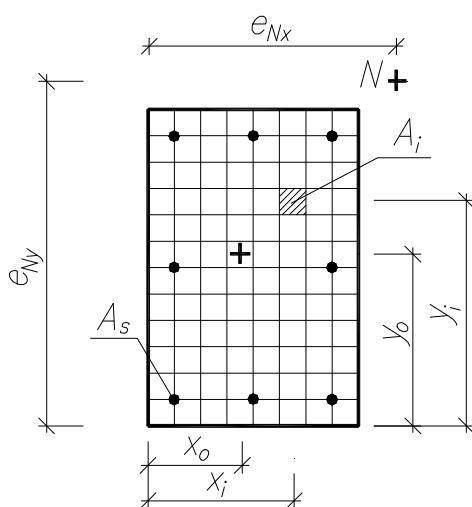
Расчетное поперечное сечение кососжатого железобетонного элемента
